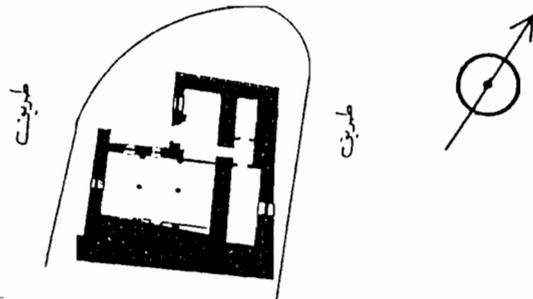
مسقط أفقي لجامع الناقاة عن الموسوعة (الجزء الأول).
